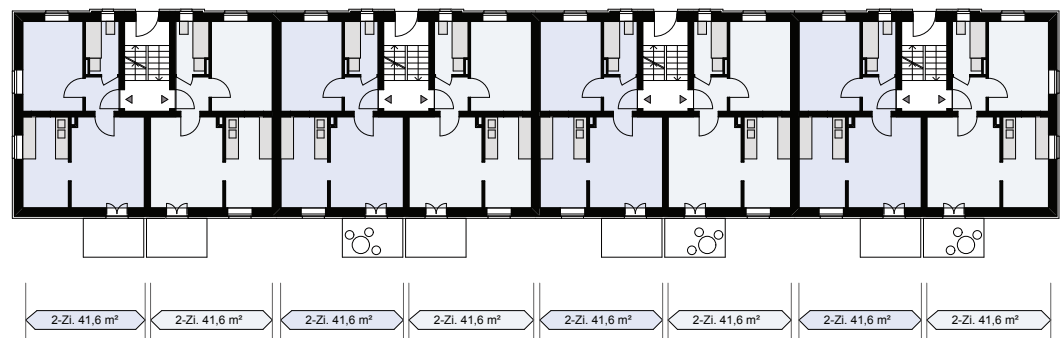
Grundrisse Regensburg, Theodor-Sturm-Straße 8–14
